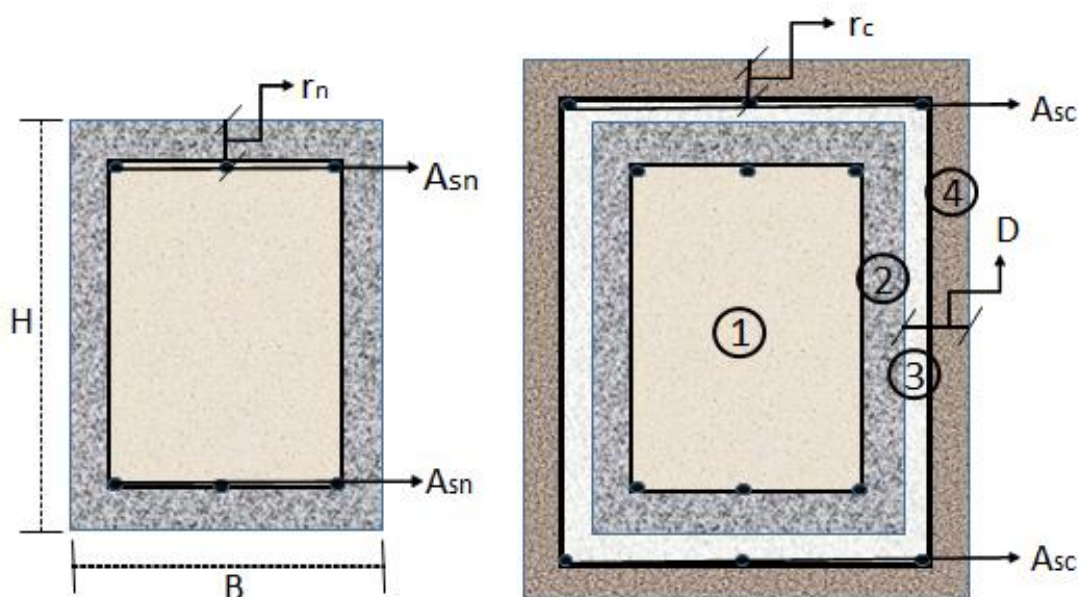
Secciones transversales de la columna original y recrecida. Fuente: propia.
